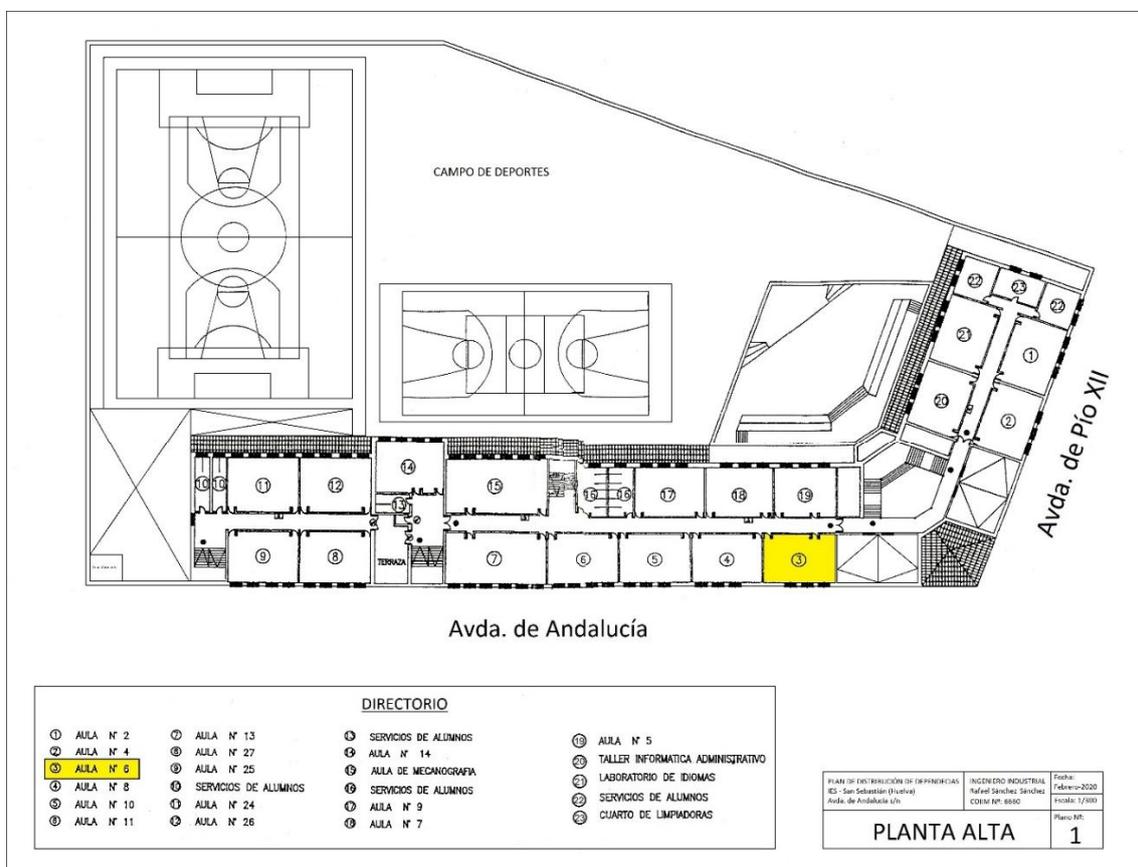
Plano de ubicación de las dependencias del IES S. Sebastián, en la planta alta
